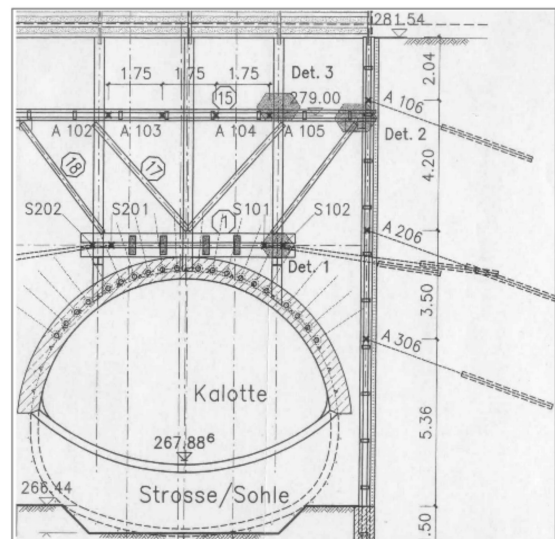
Tunnelportal und Trägerbohlwand einer Spritzbetonschicht auf der Anschlagfläche ersetzt [4].
